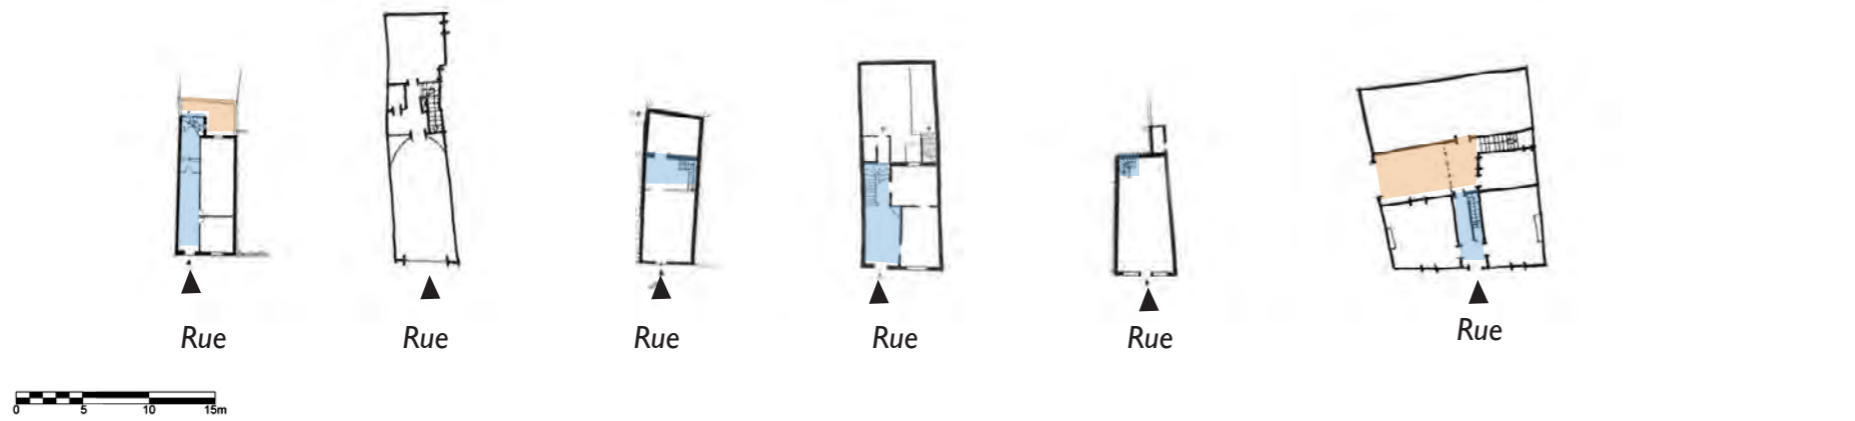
Plans rez-de-chaussée des maisons commerçantes et de faubourg
